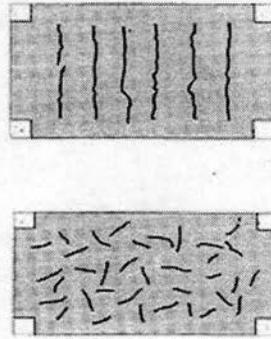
Fisuras de contracción hidráulica y térmica
